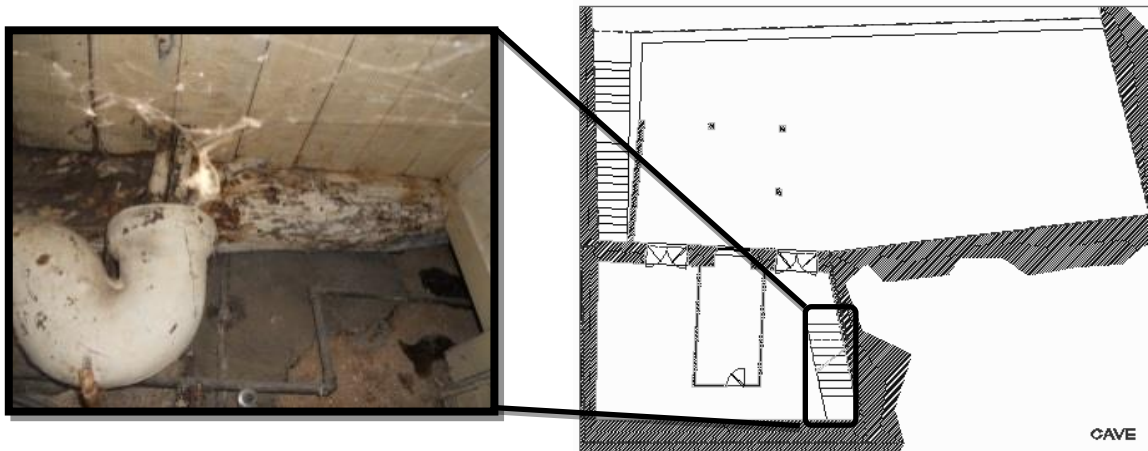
Anomalia 4 - Fotografia e localização na planta
